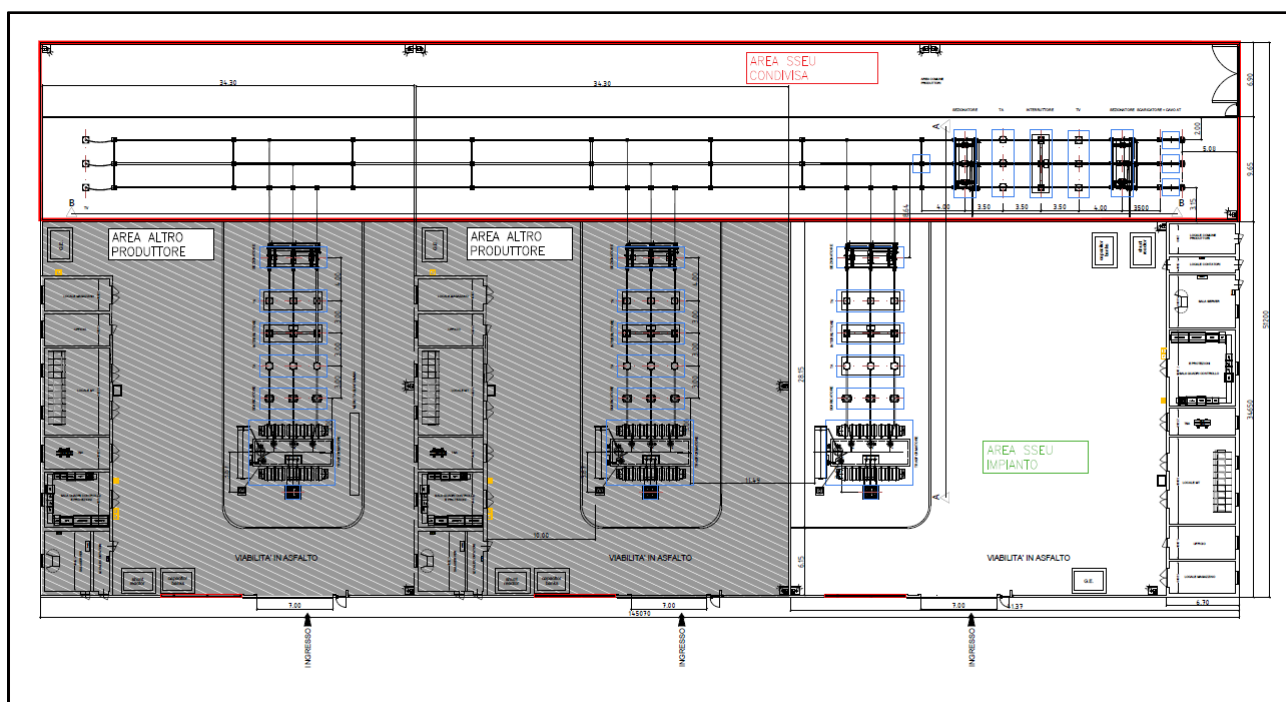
Sotto stazione utente – SSE – Prospetto
